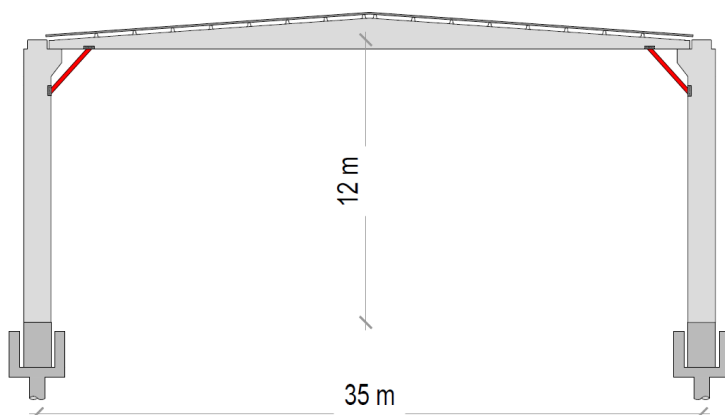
Esquema do reforço proposto para a ligação viga-pilar
